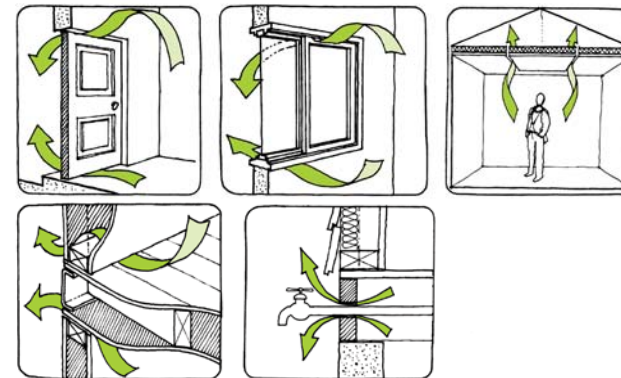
Infiltraciones de aire no deseables en la envolvente de la vivienda.
